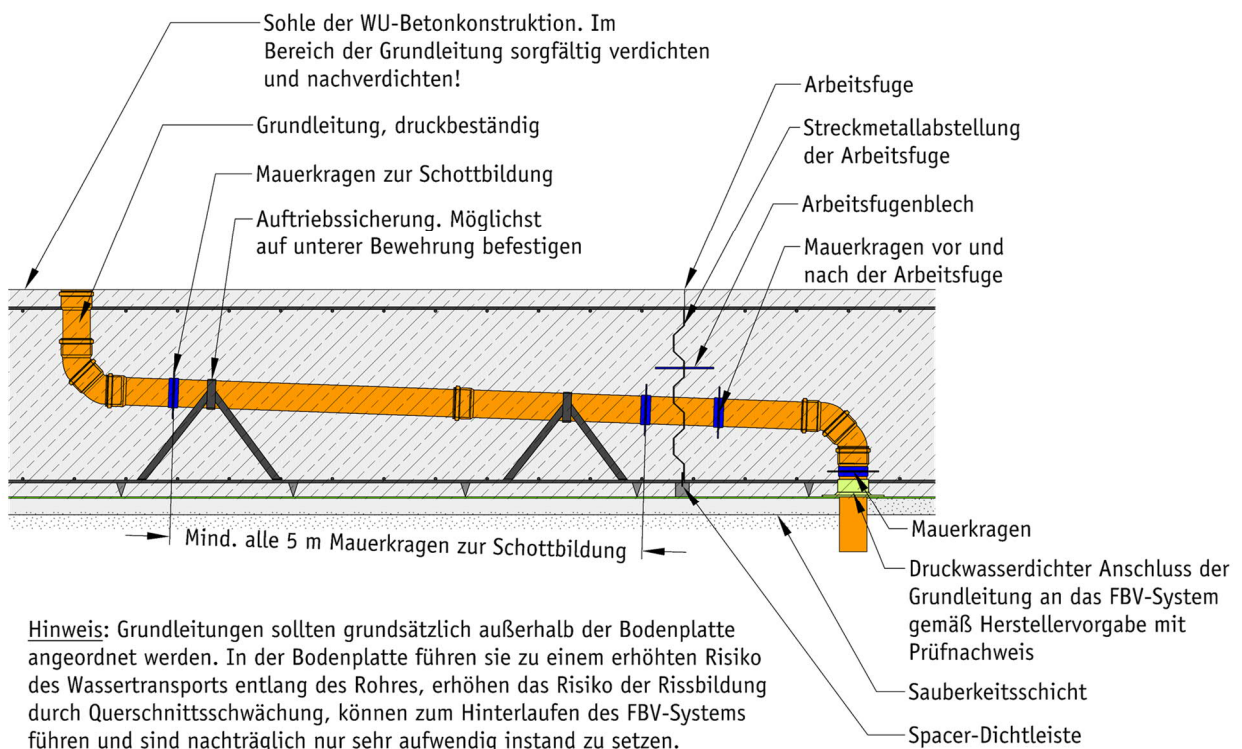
Prinzipiendarstellung Rohrdurchführung mit Verzug
